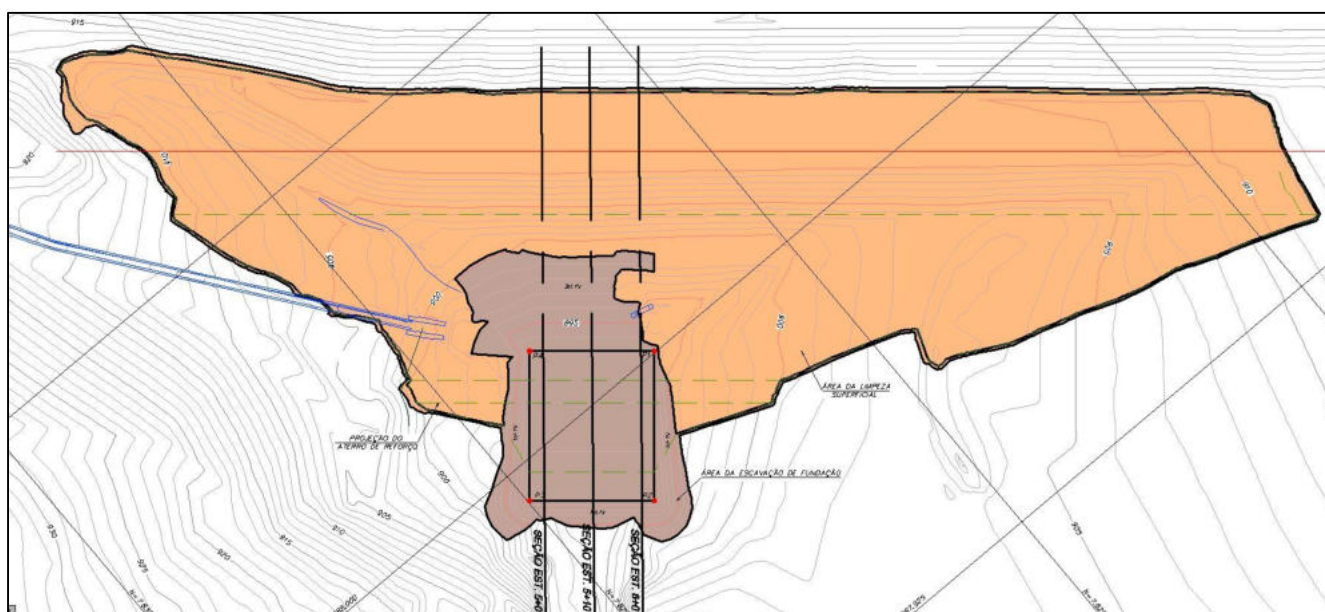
Tratamento de Fundação para Reforço – Barragem B5
